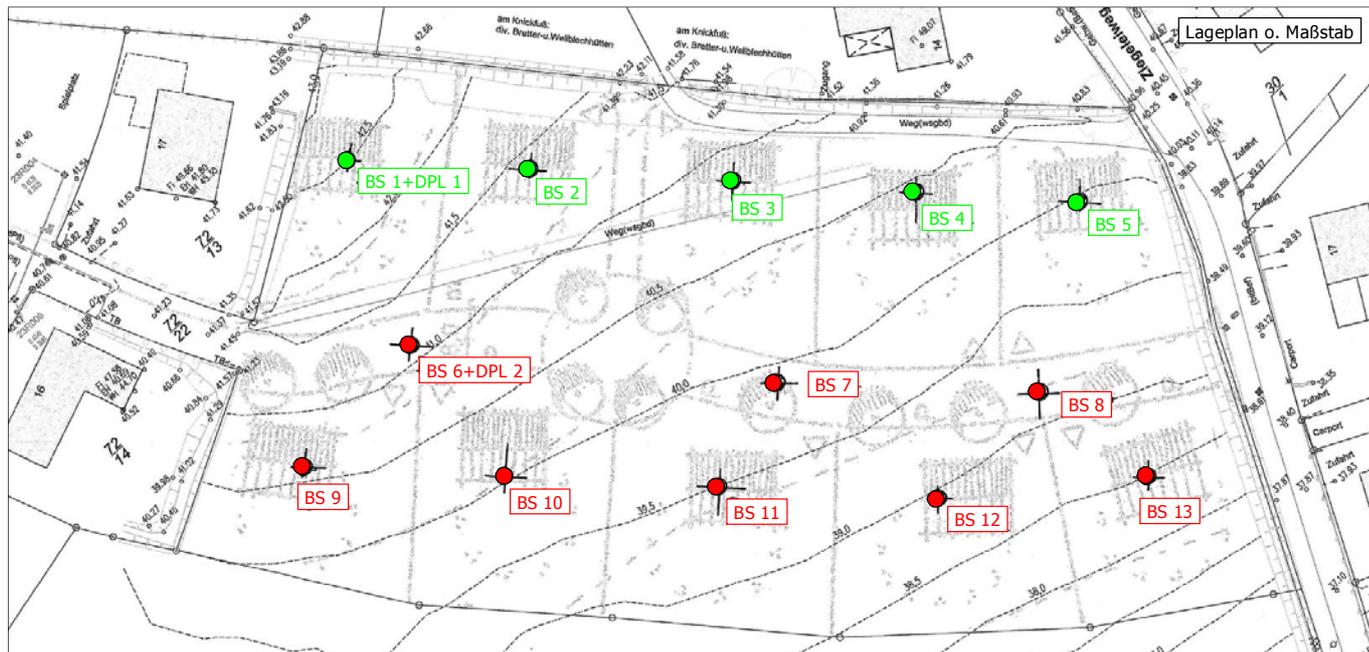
Lageplanausschnitt aus Anl. 1.2\_B (o. M.)
